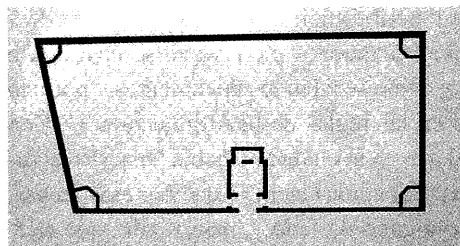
Plano del cementerio de Canido. Reconstrucción conjetural (Dibujo de Vicente Vigo).
